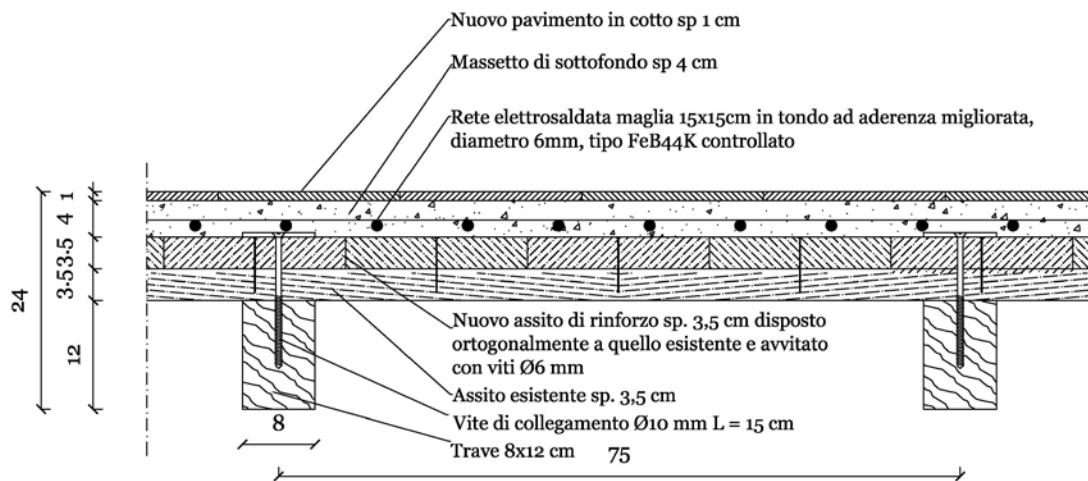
Schema solaio stanza 22.1 – Progetto ing. Jurina
